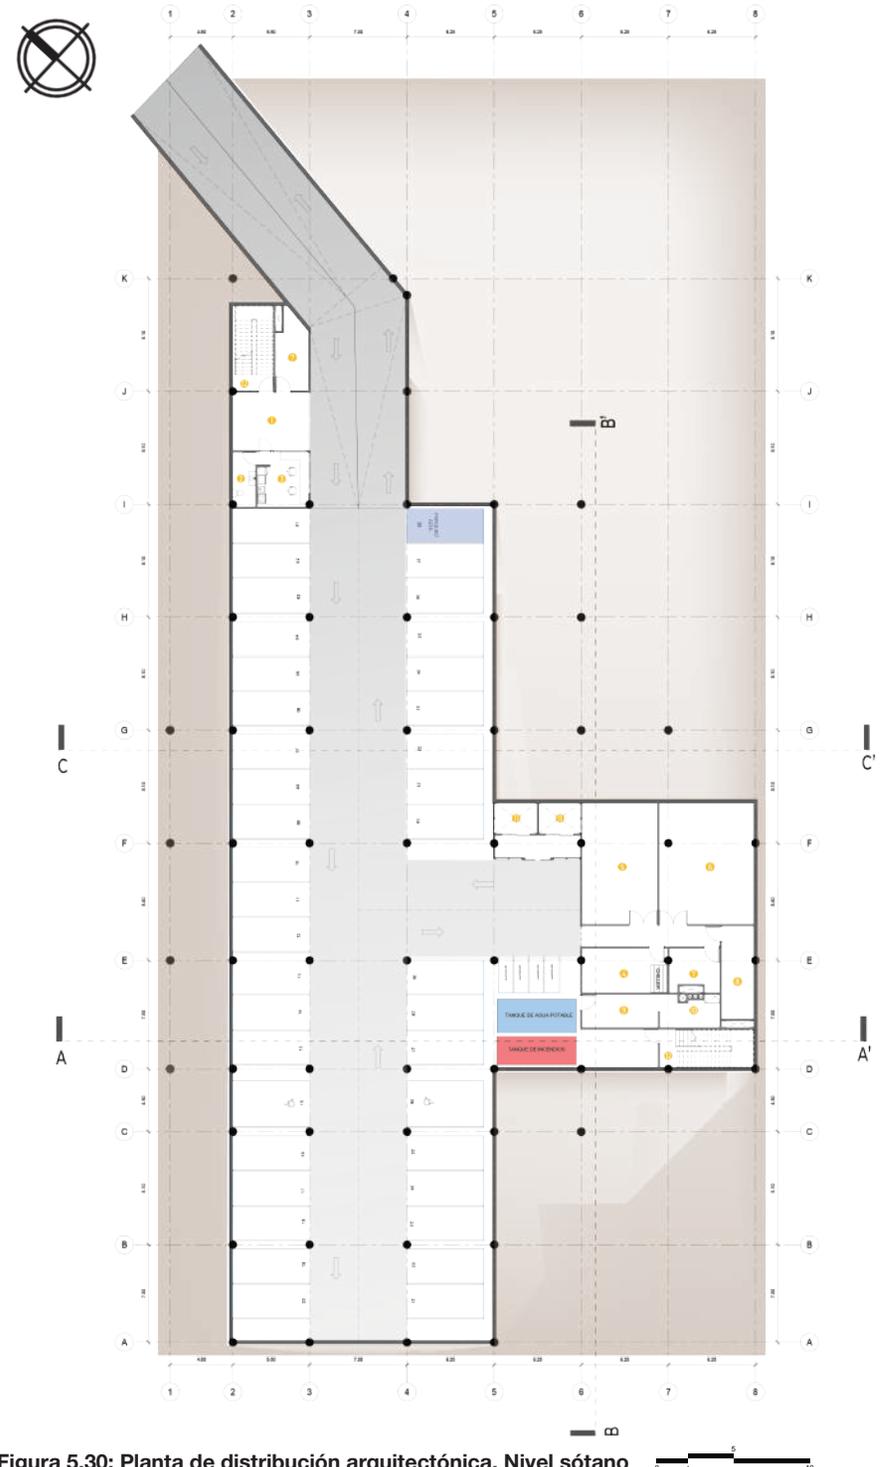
Planta de distribución arquitectónica. Nivel sótano
